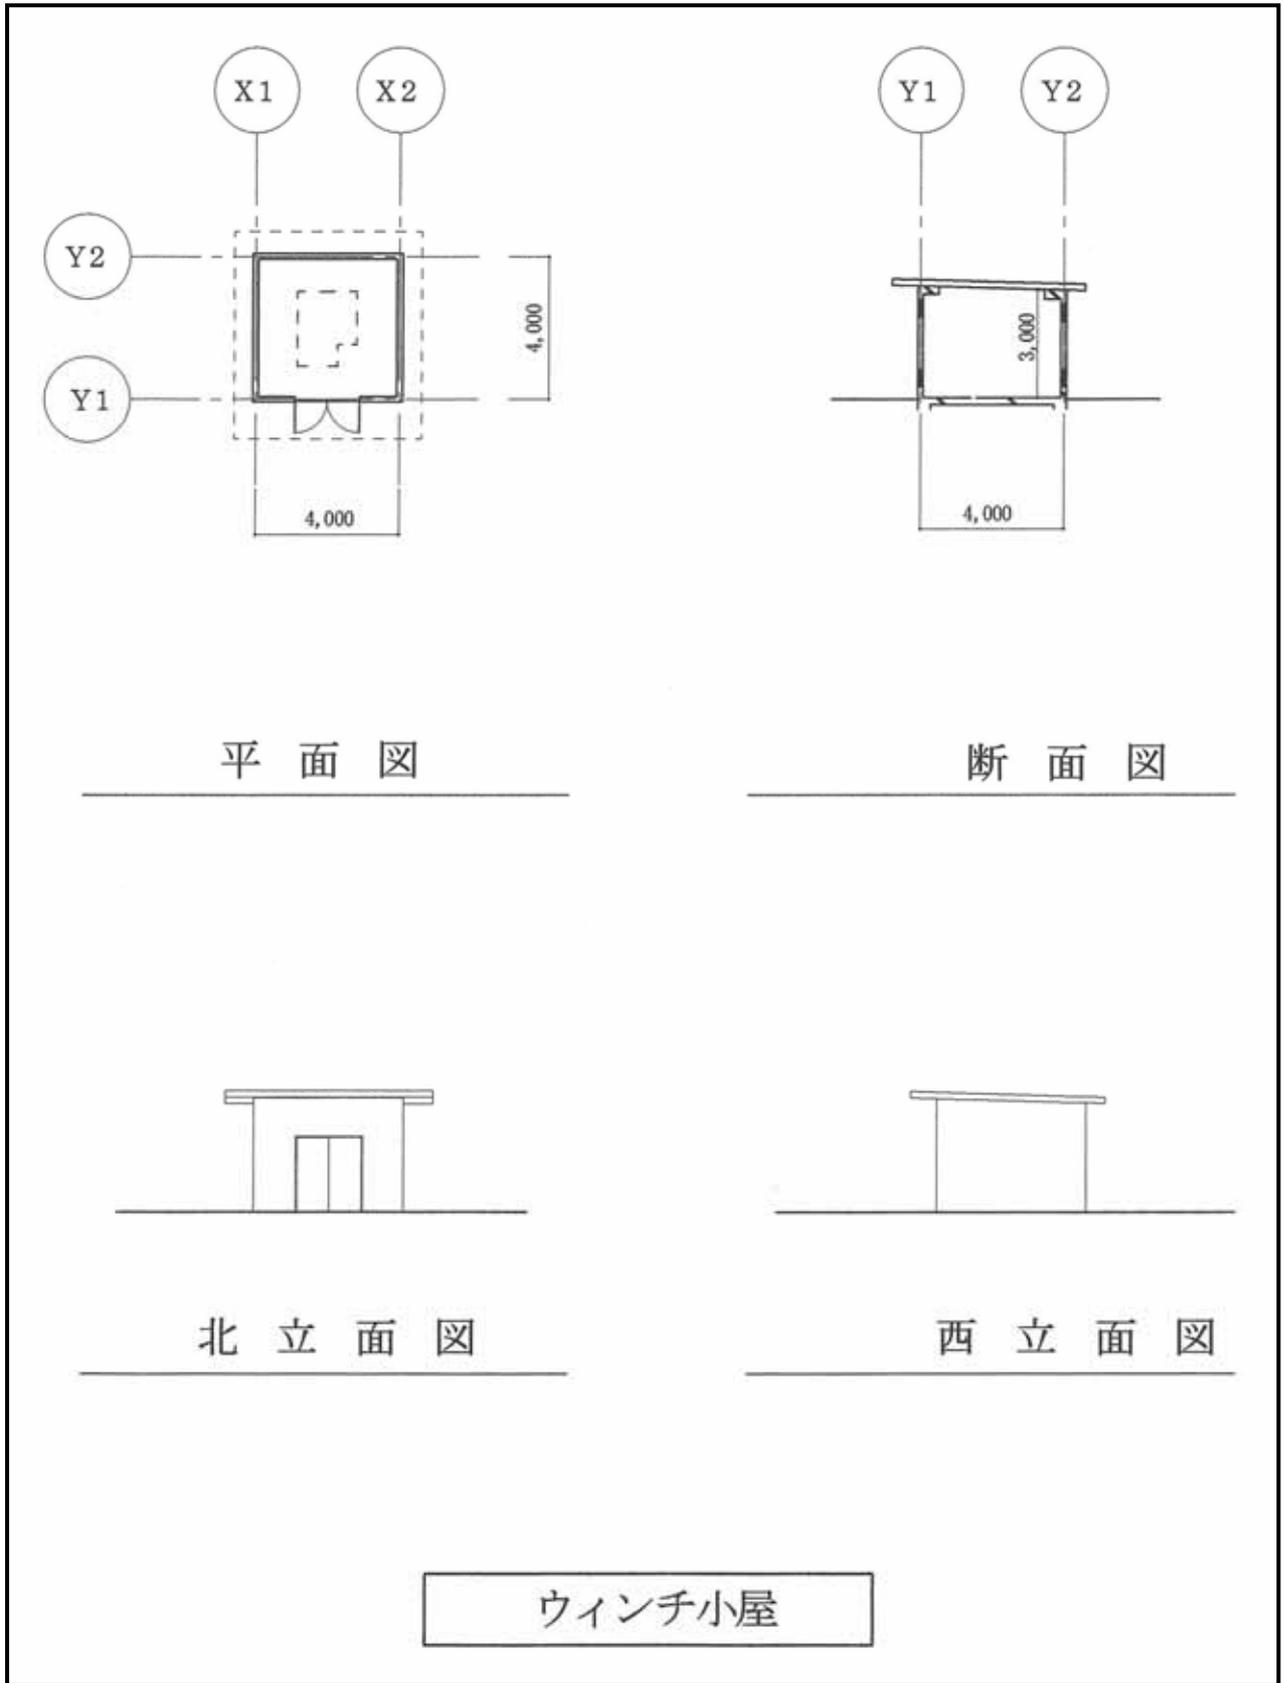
ウィンチ小屋 平面・断面・立面図
